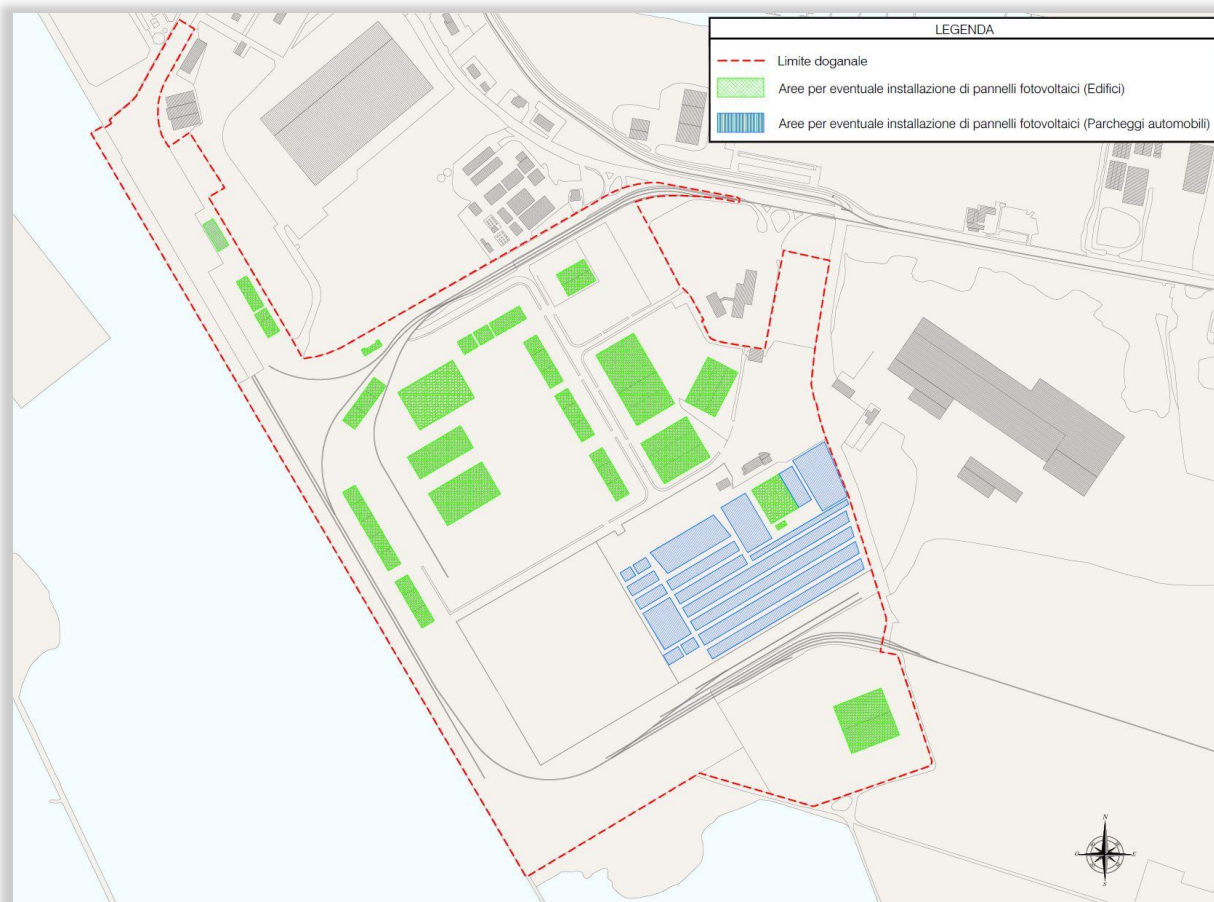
Planimetria delle aree da destinare eventualmente all'installazione di pannelli fotovoltaici
